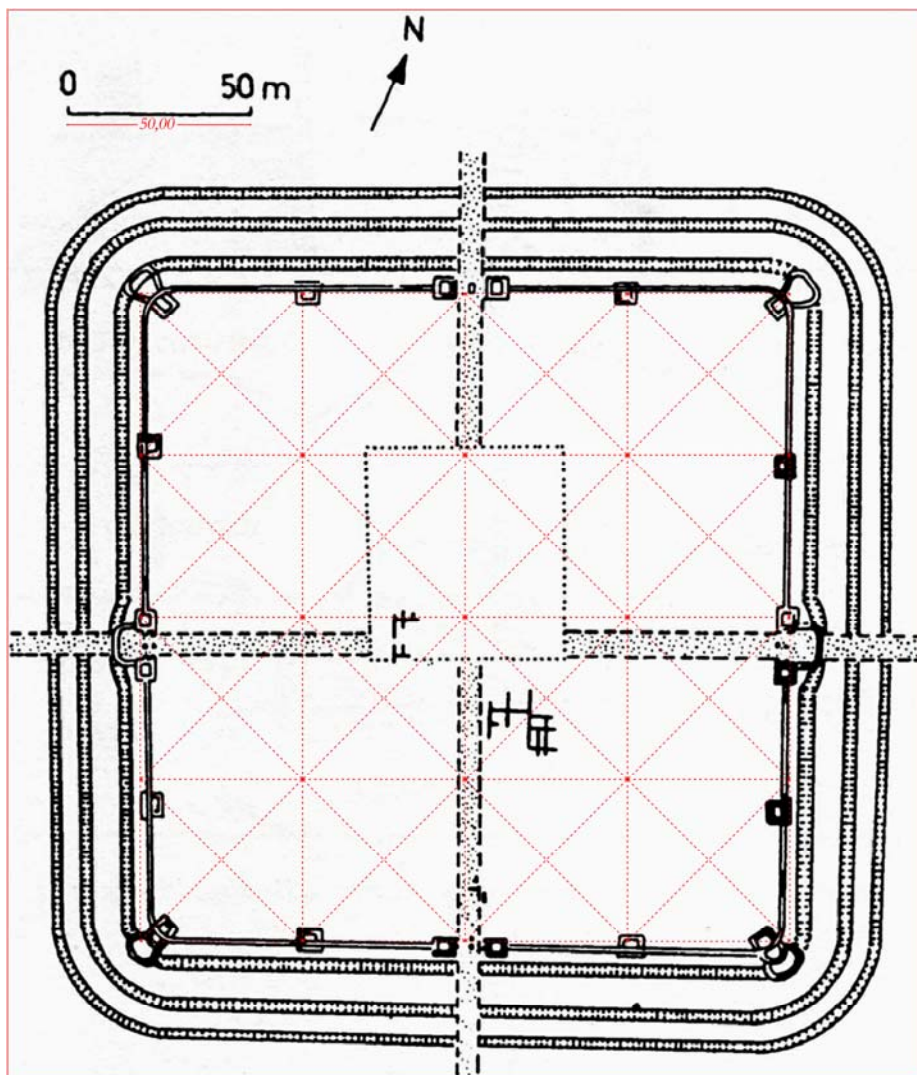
Application du module sur le plan de Nagytetény-Campona²²⁰,
